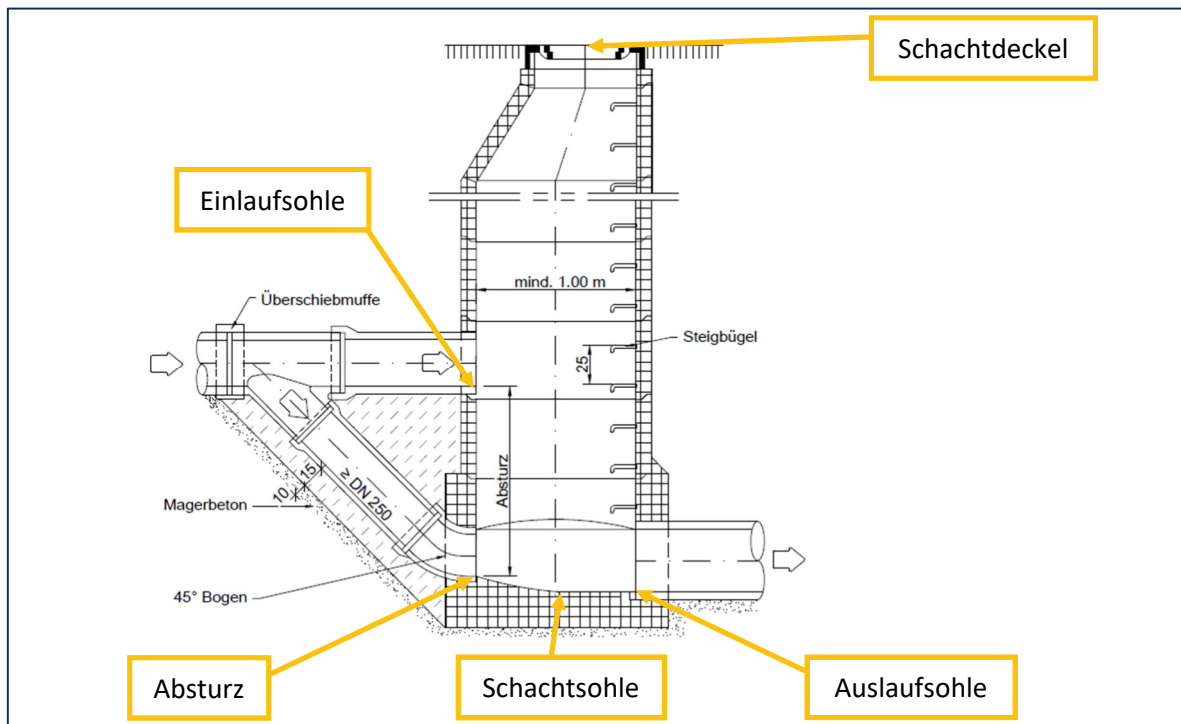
Prinzipskizze Schachtaufbau rund Absturzbauwerk mit außenliegendem Untersturz
